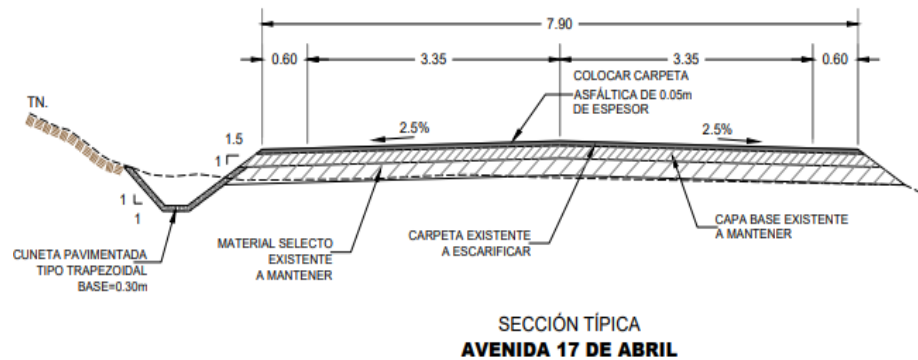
Sección típica Ave. 17 de abril. Fuente: Planos del proyecto
